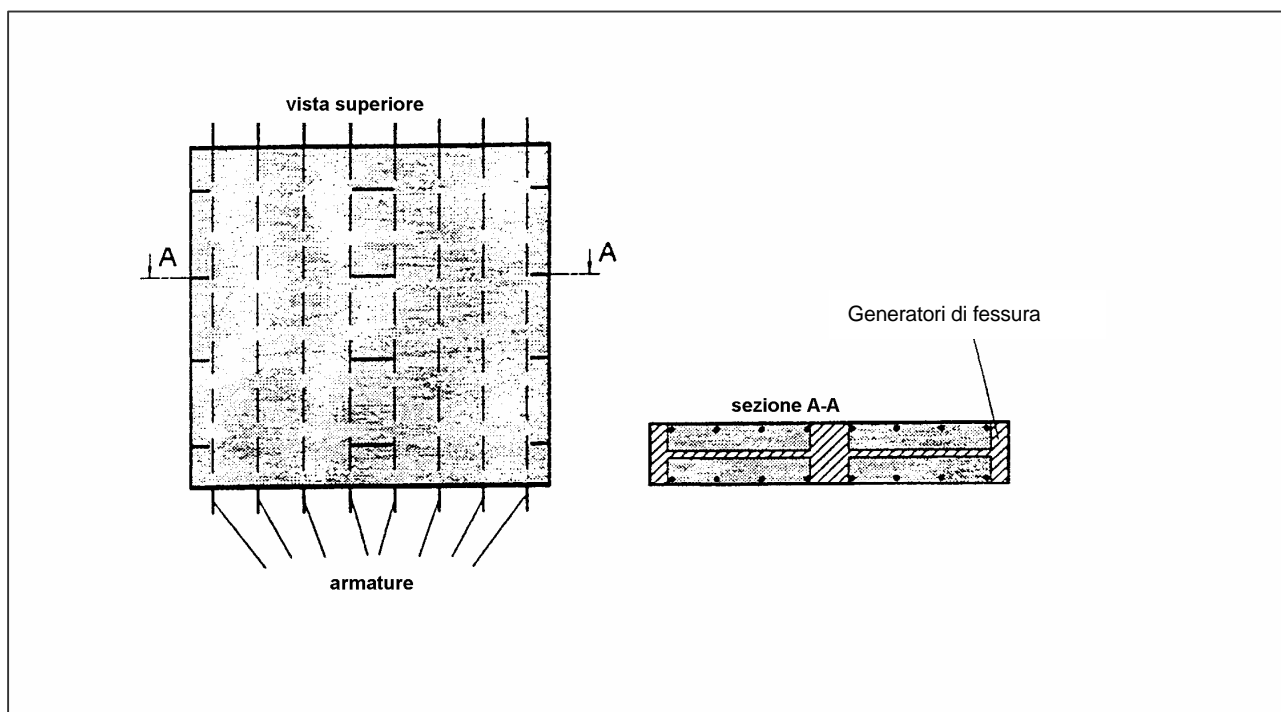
Esempio di un supporto di prova per ancoranti testati su calcestruzzo fessurato
